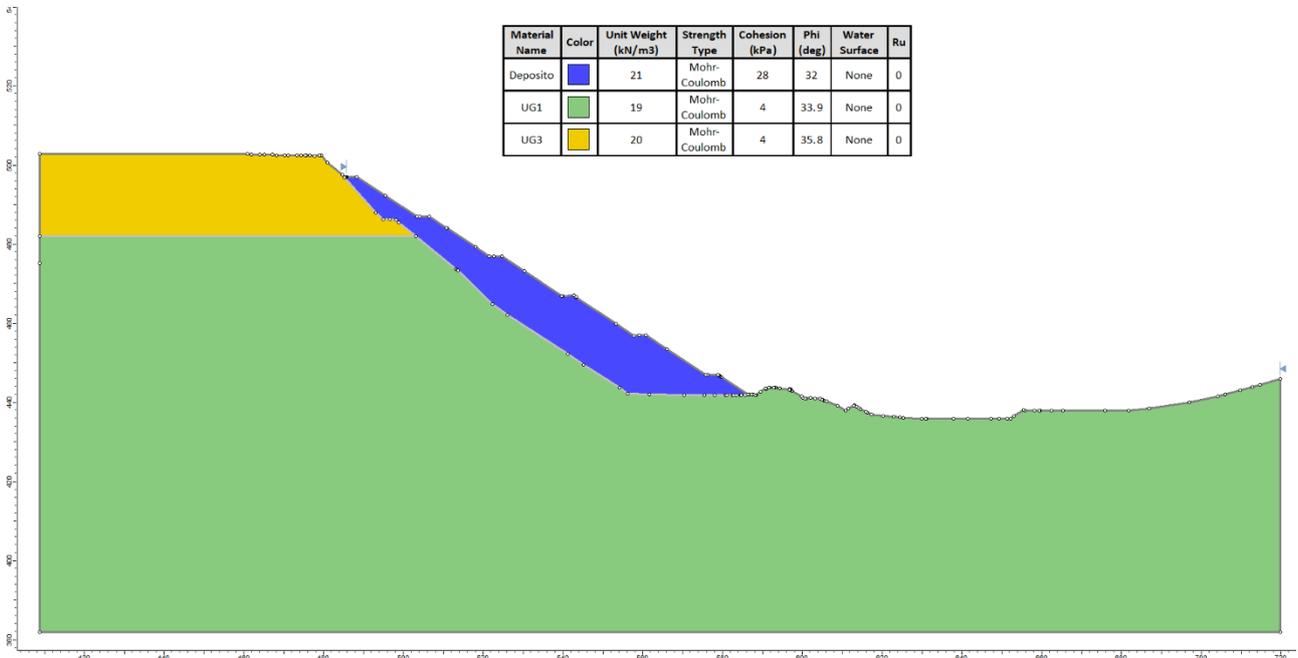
Deposito di Plattner – Modello di calcolo – Sezione 2-2
